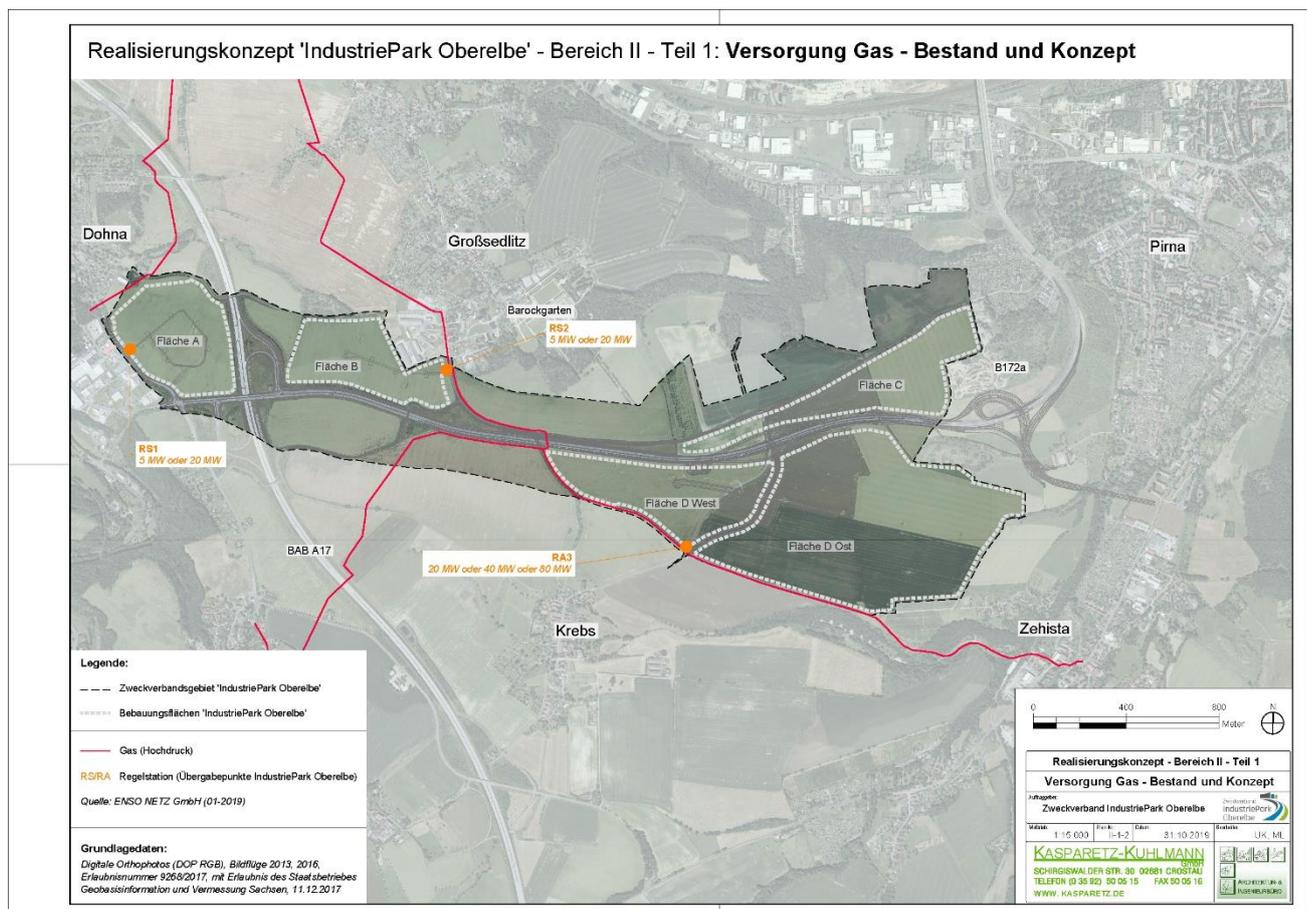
Karte II-1-2: Versorgung Gas – Bestand
